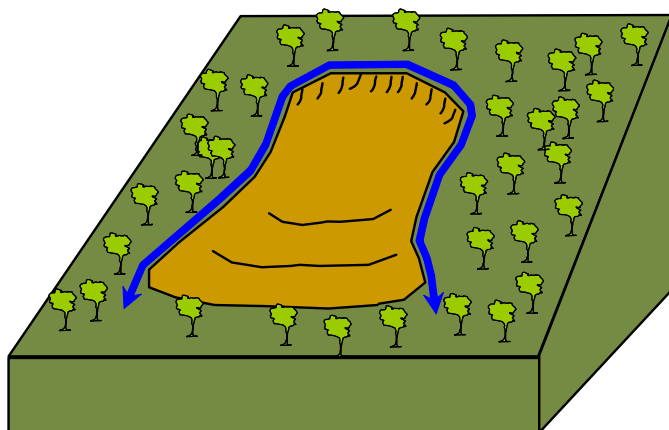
Rappresentazione schematica dell'effetto prodotto da un fosso di guardia (porzione sommitale) e di perimetrazione (porzioni laterali) su di un corpo in frana: le acque provenienti dal versante vengono intercettate ed allontanate (in blu) dall'area instabile, evitandone sia gli effetti erosivi associati al ruscellamento superficiale che la potenziale infiltrazione -
